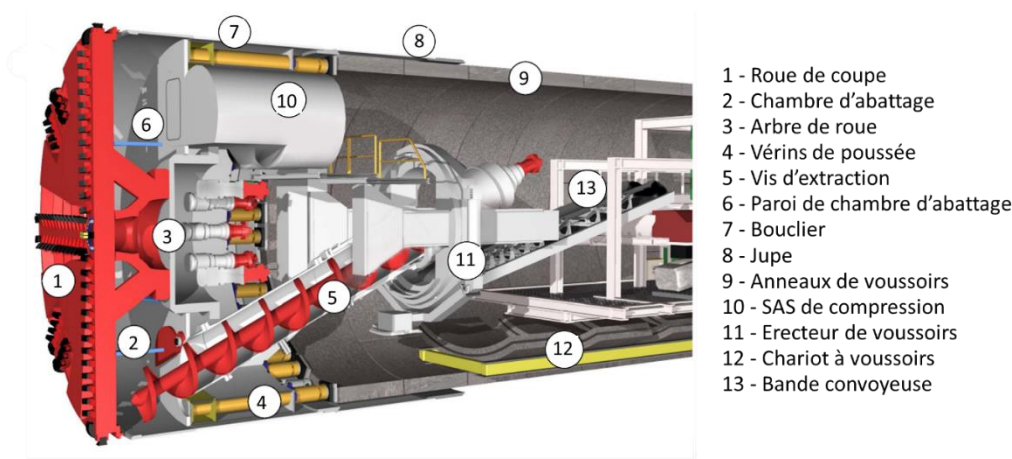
Schéma de principe d'un tunnelier à pression de terre (source : Herrenknecht)
